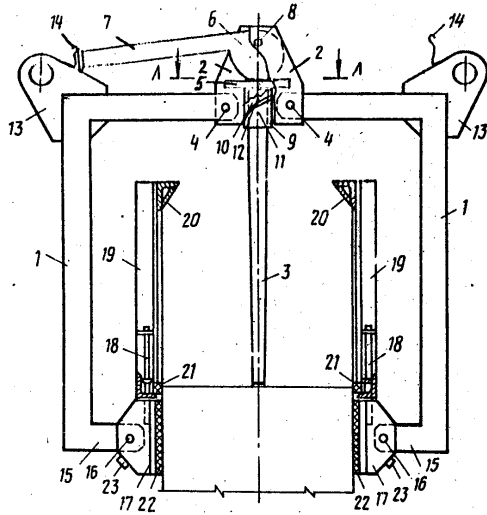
Опалубка для возведения линейных железобетонных сооружений [14]: 1 – Г-образный элемент рамы; 2 – пластина рамы; 3 – выдвижная колонна; 4 – шарнир; 5 – опорная пята; 6 – эксцентрик; 7 – рукоятка; 8 – шарнир; 9 – цилиндр регулятора высоты; 10 – винтовая ступенчатая прорезь цилиндра; 11 – цилиндрический ползун; 12 – фиксатор, вставленный в винтовую ступенчатую прорезь; 13 – монтажная петля; 14 – фиксатор рукоятки; 15 – кронштейн; 16 – шарниры; 17 – упорная пята; 18 – разъемные шарниры; 19 – опалубочные щиты; 20 – угловые скосы; 21, 22 – эластичные прокладки; 23 – ограничитель поворота.
